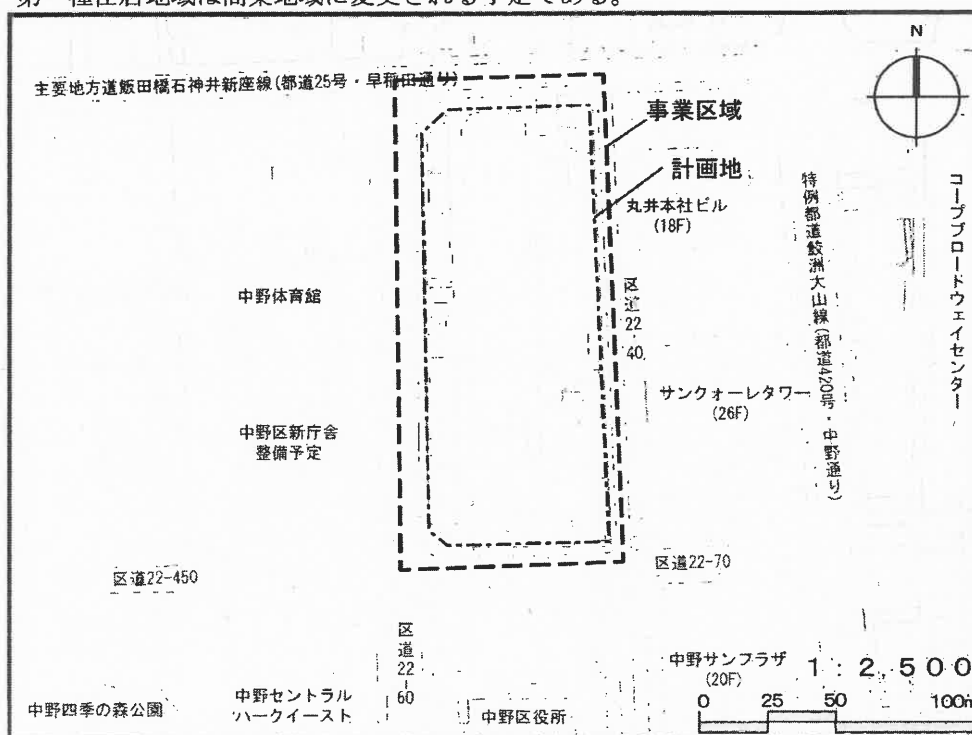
(1) 事業区域及び計画地位置図（現況図）
